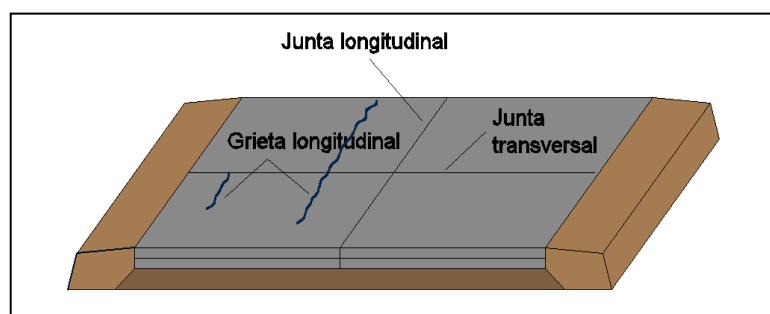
Esquema de grietas longitudinales en la calzada
